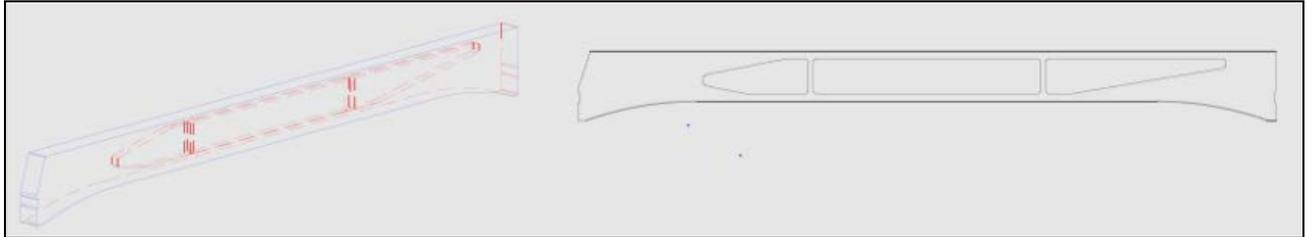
Modelagem da viga-guia Tipo.
